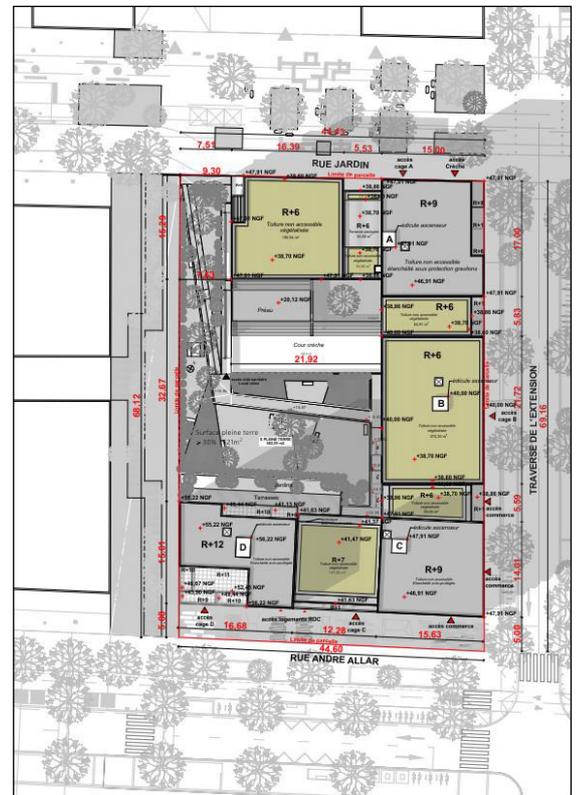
Plan du projet retenu sur l'îlot 5C3
